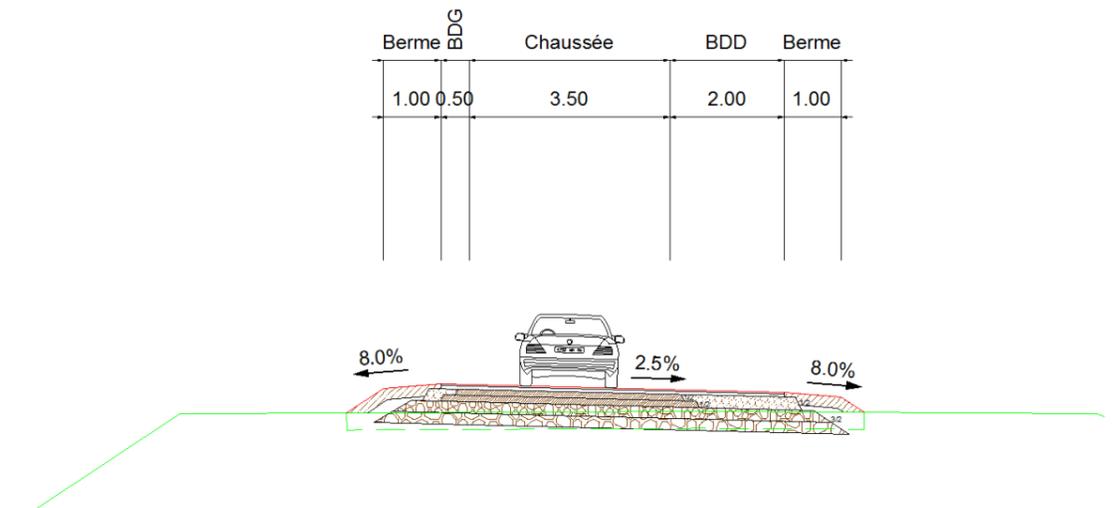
Profils en travers des bretelles de l'échangeur avec la RD 366 (source ARCADIS)
